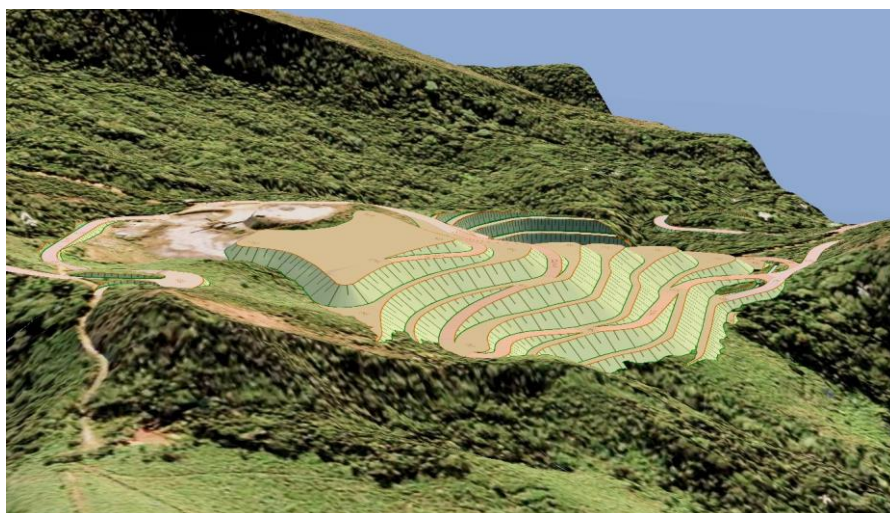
Configuração Futura da Pilha de Estéril (Vista 01).
